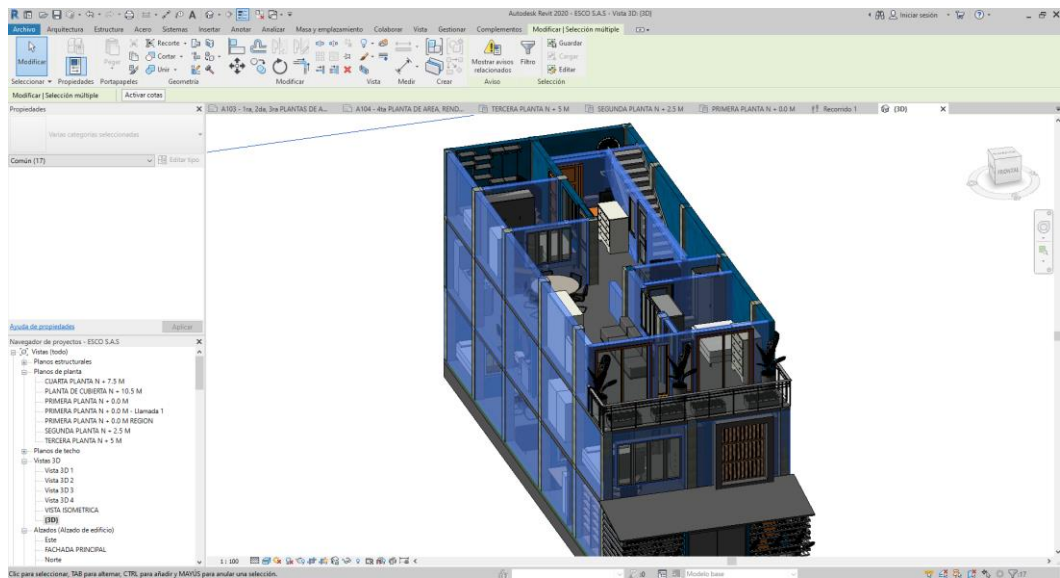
Corte de la tercera planta. Revit. Fuente elaboración propia.
